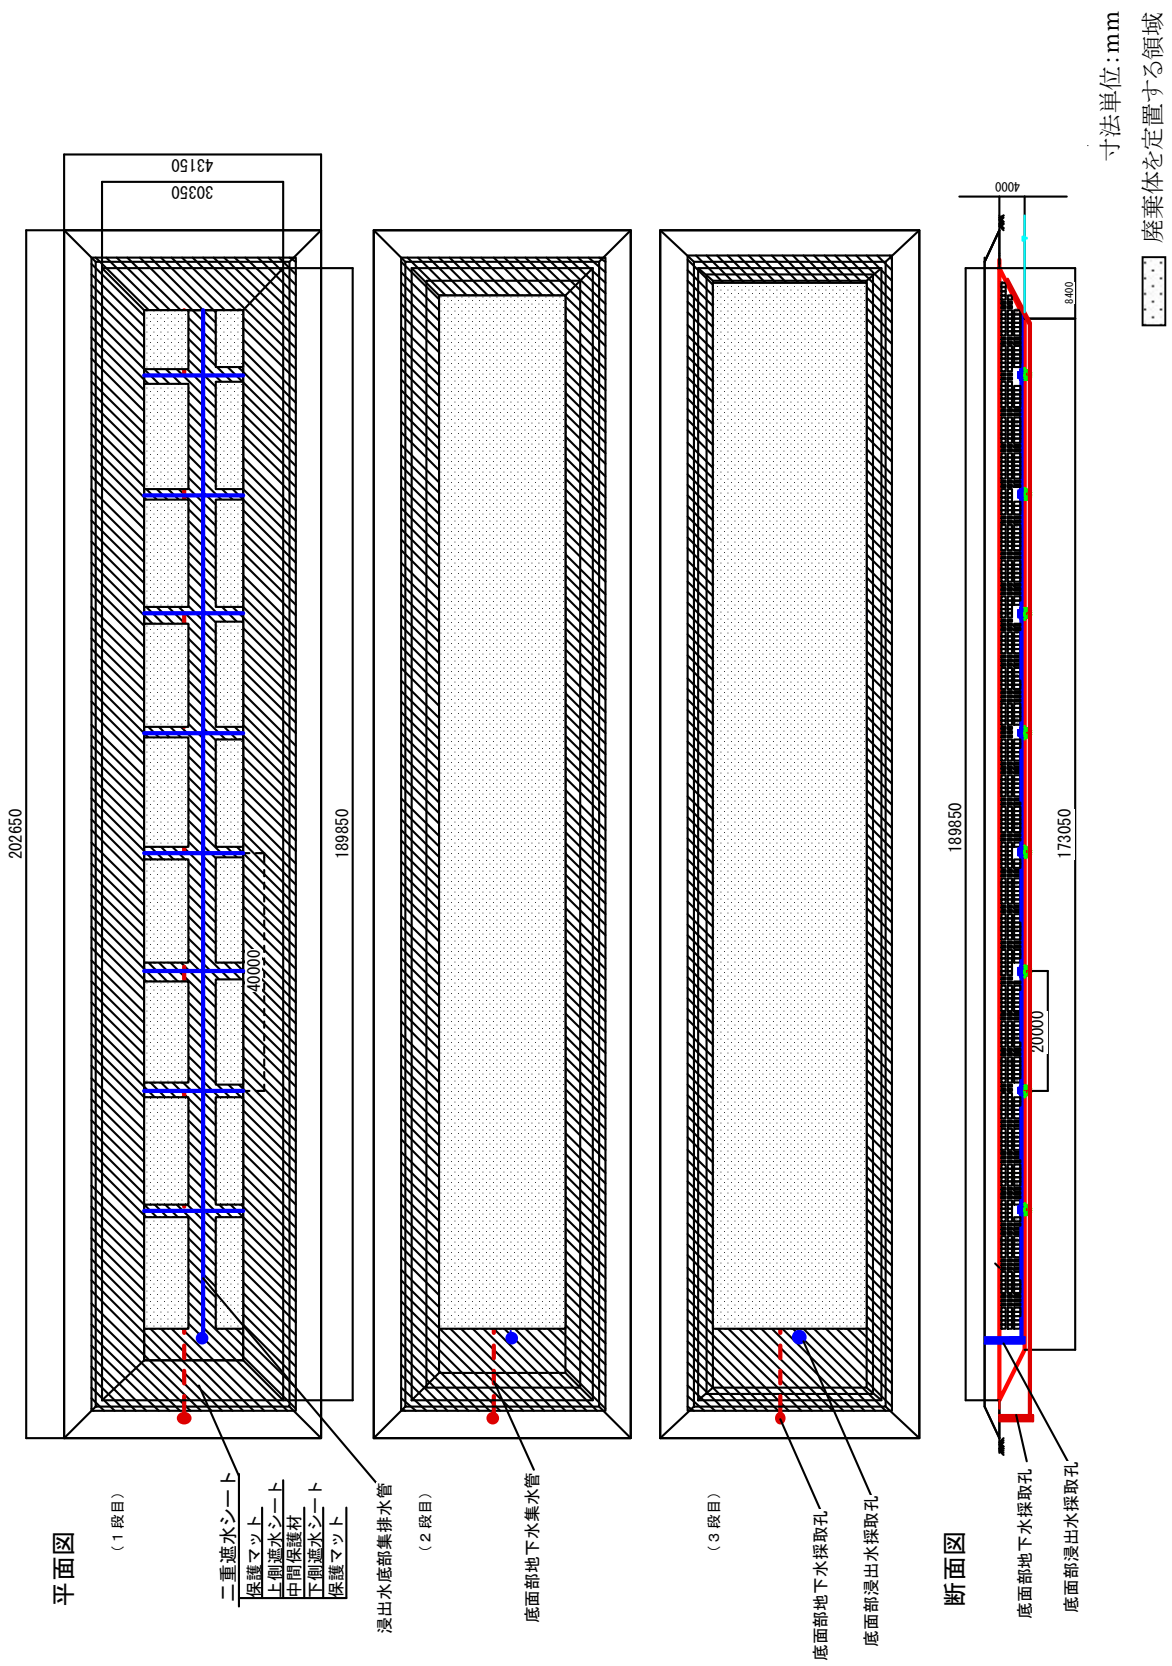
付加機能型トレンチ埋設設備長尺平面及び断面図 (P埋設地)
